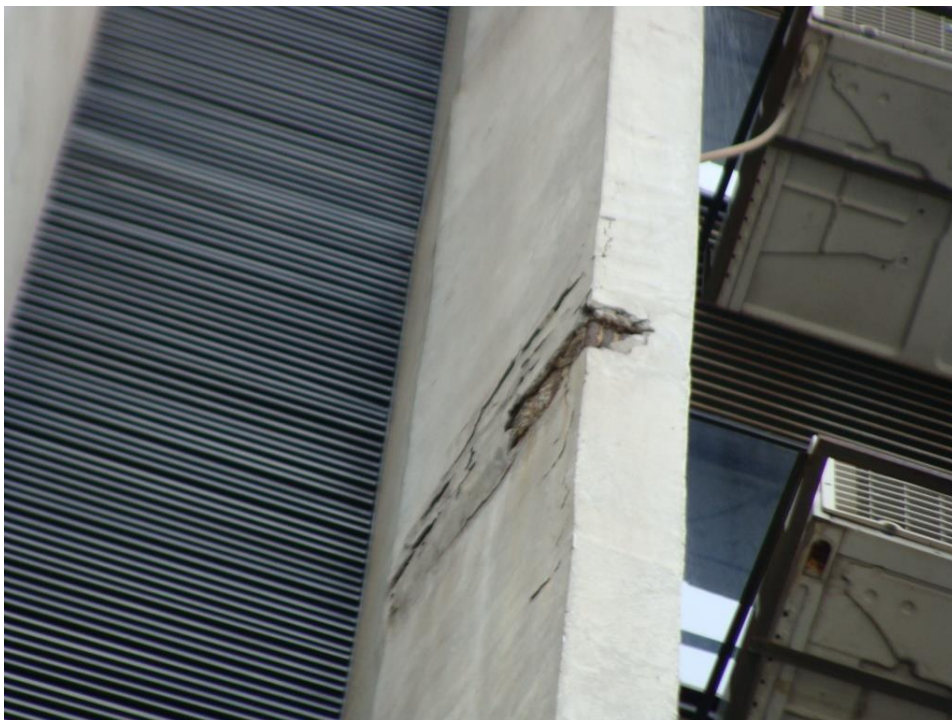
Armadura exposta pilar P13 (4º pavimento) (02/03/2021)
